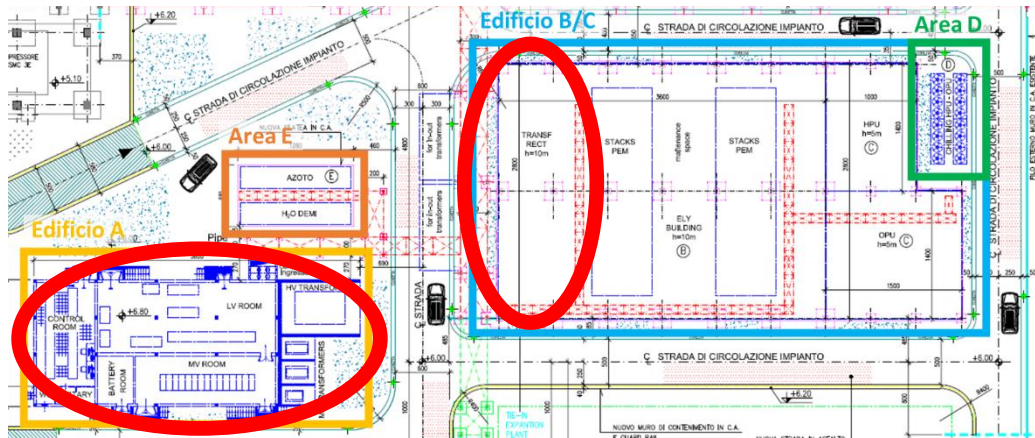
Layout dell'impianto – particolare alimentazione e distribuzione elettrica
